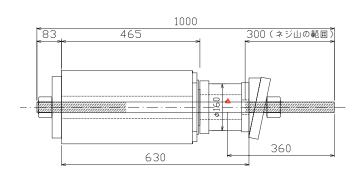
曲げ張試験状況 (総ねじPC 鋼棒の例)
